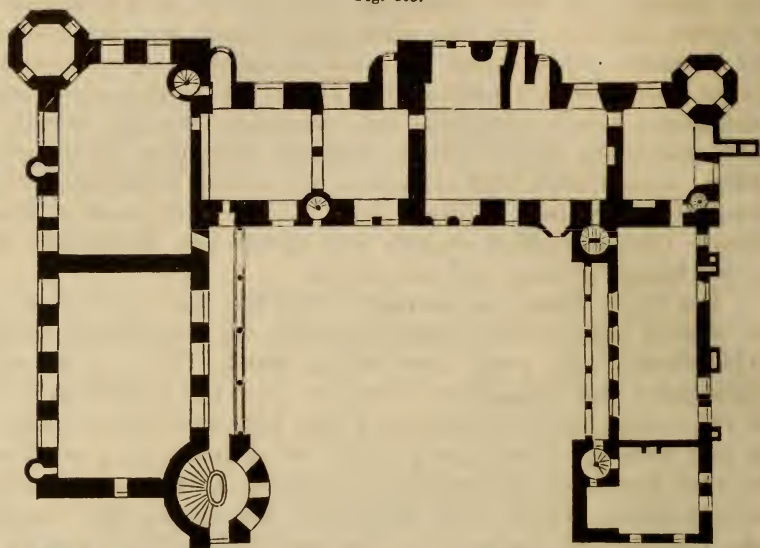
Grundriss des Schlosses zu Güstrow.
